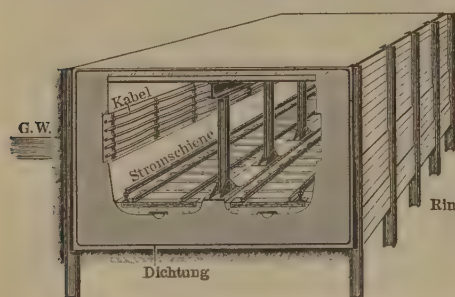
Tunnelstrecke der elektrischen Hoch- und Untergrundbahn zu Berlin im Grundwasser.
